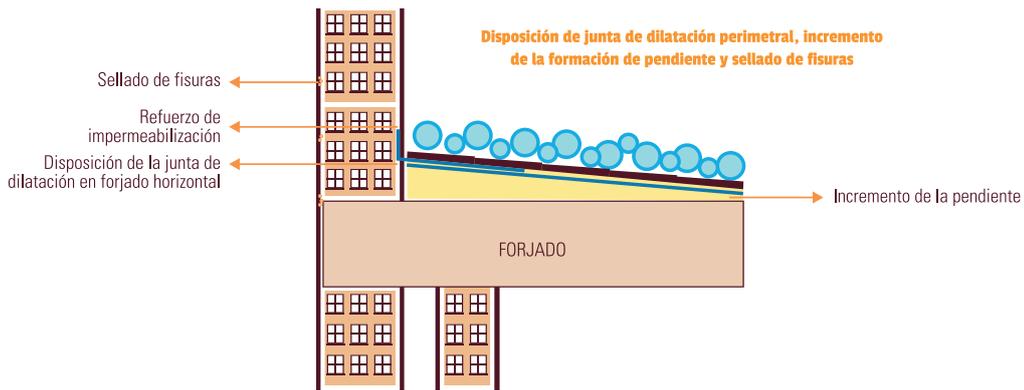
Disposición de junta de dilatación perimetral, incremento de la formación de pendiente y sellado de fisuras
